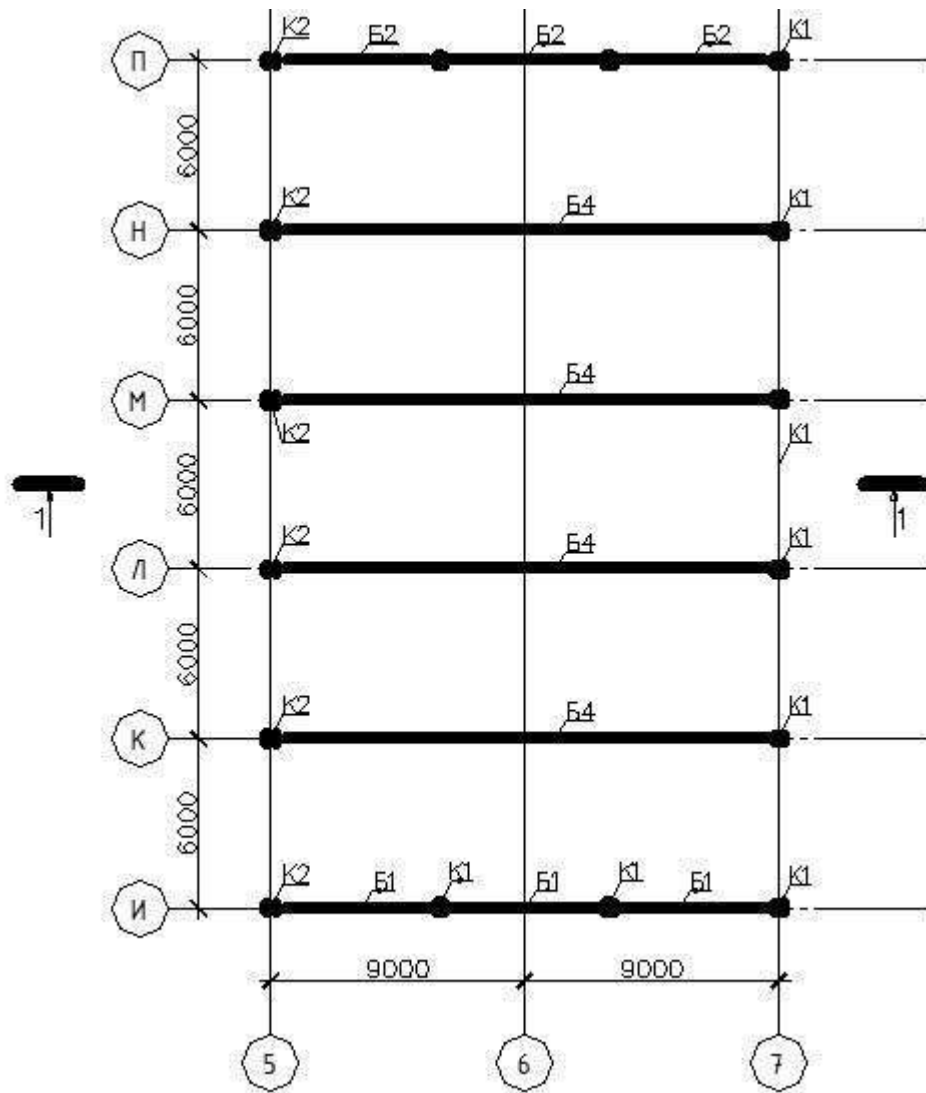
Схемарасположениябалок перекрытия в осях И-П; 5-6.
